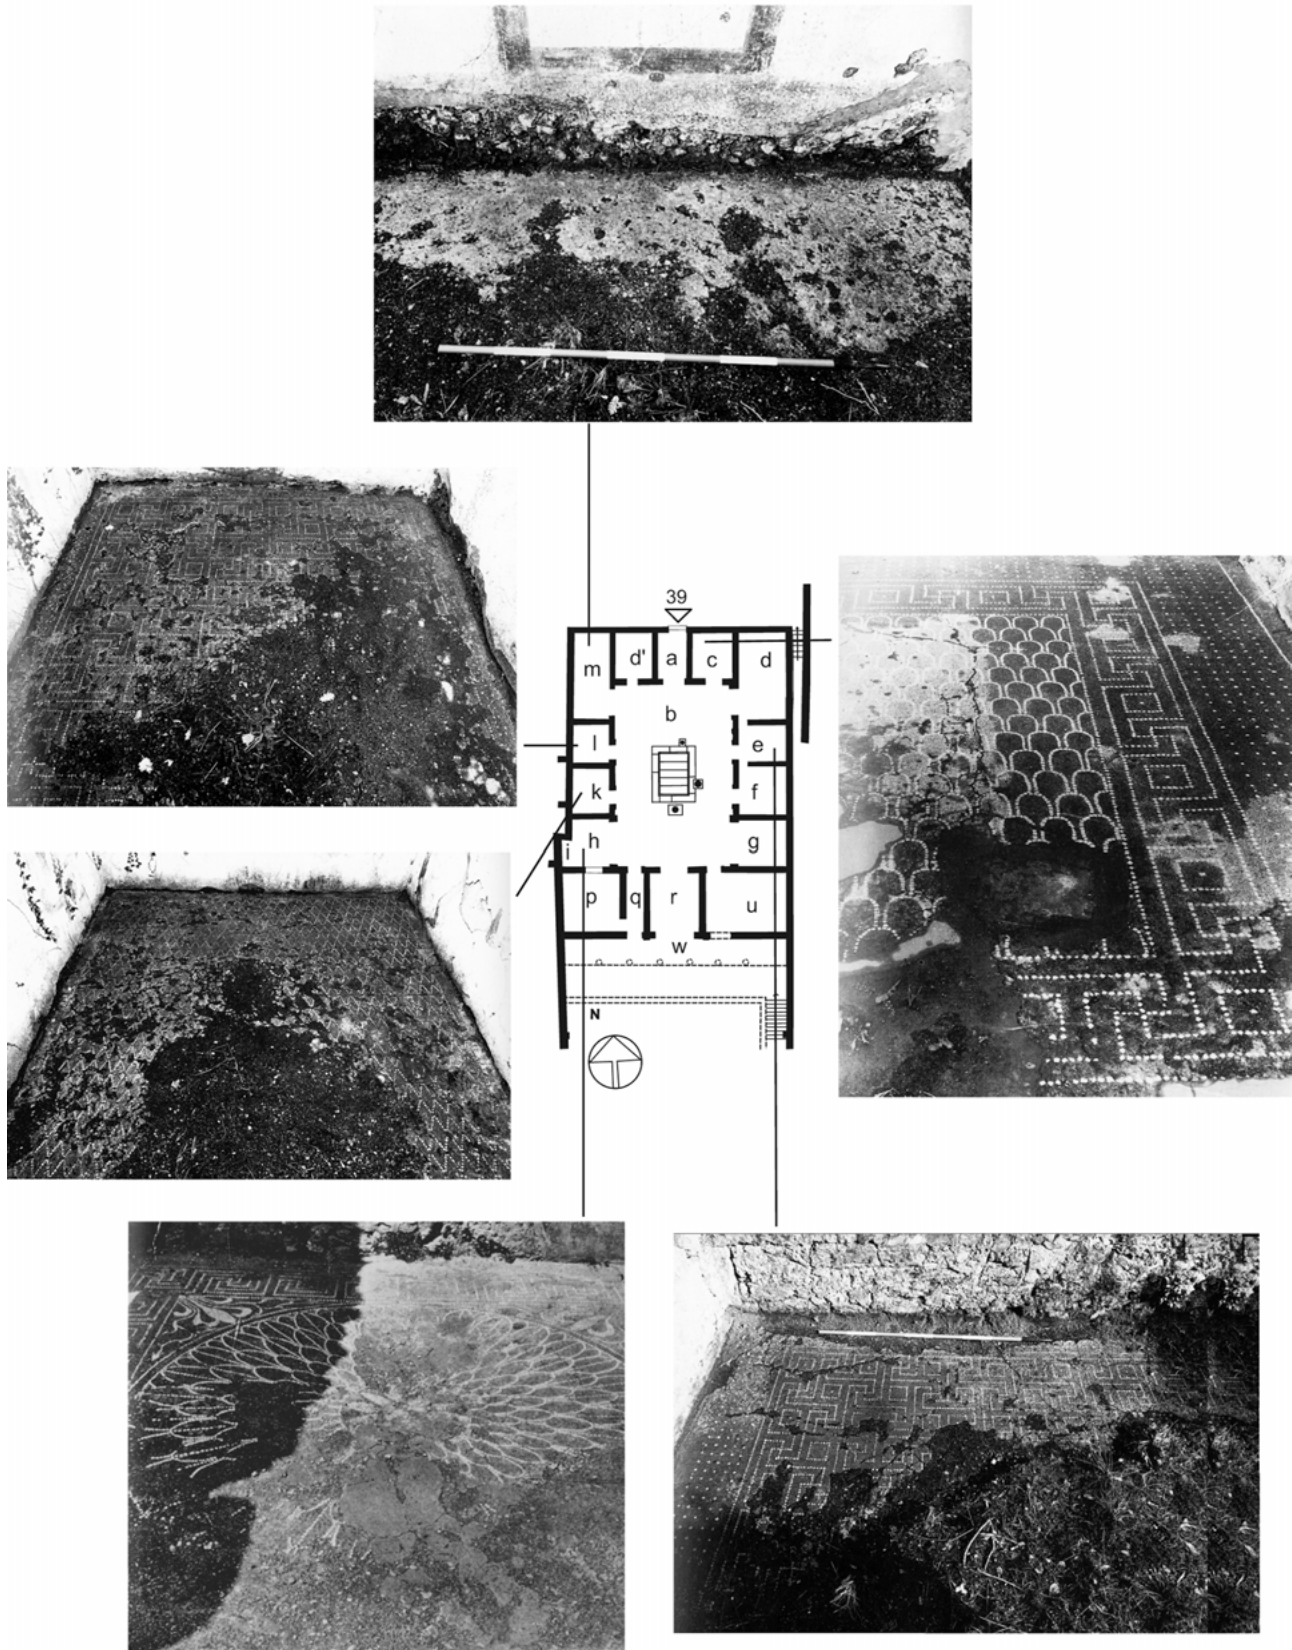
Casa di Giuseppe II (VIII 2,39), Grundriss mit Pavimenten.
